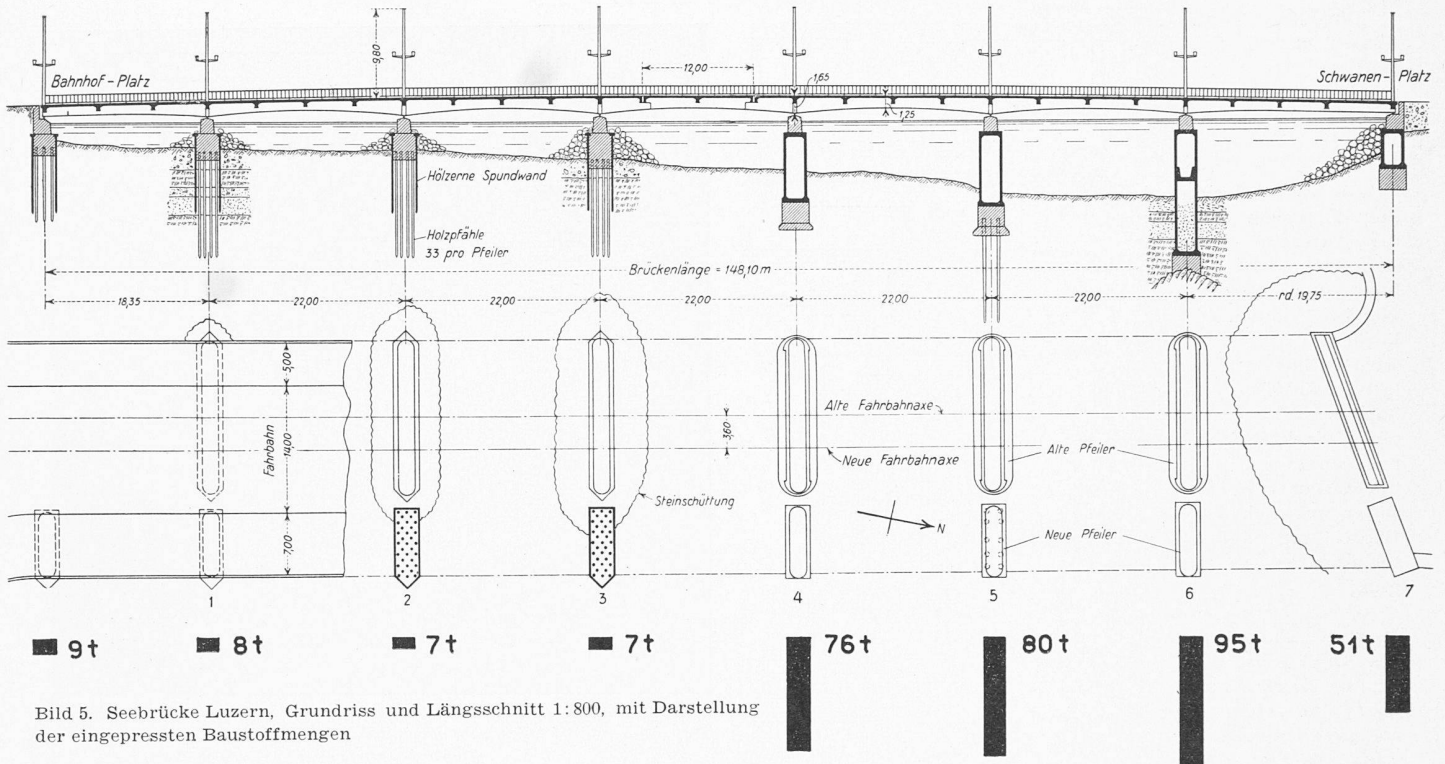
Seebrücke Luzern, Grundriss und Längsschnitt 1:800, mit Darstellung der eingepressten Baustoffmengen
